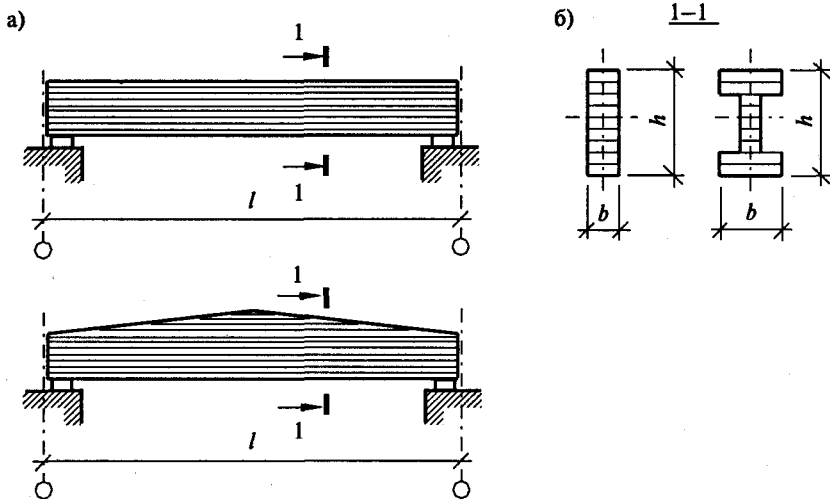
Клееные балки: а) типы клееных балок из досок; б) возможные сечения балок (прямоугольное, двутавровое)
